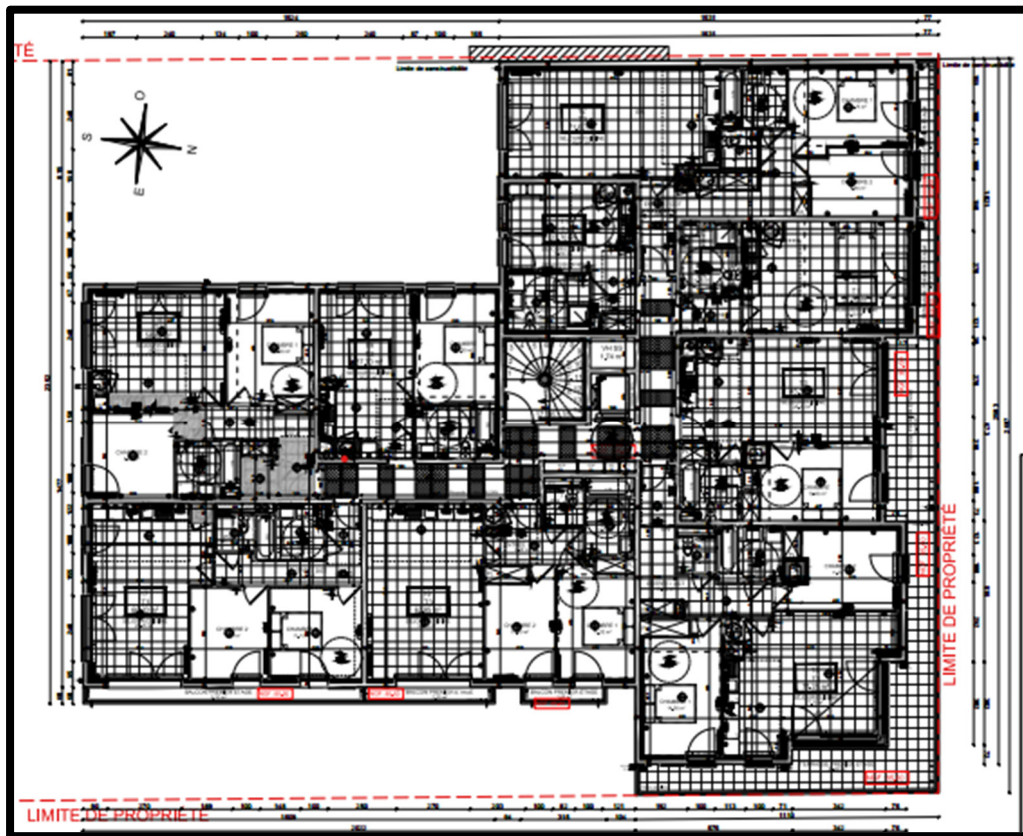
Planta piso tipo do edifício de estudo (fase projeto)
